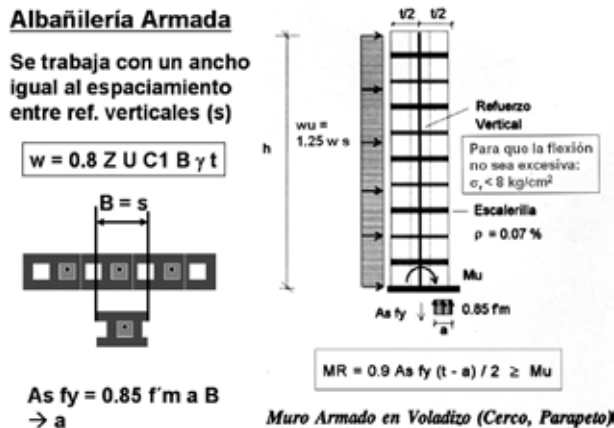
Diseño a la rotura de un cerco o parapeto de albañilería armada.
